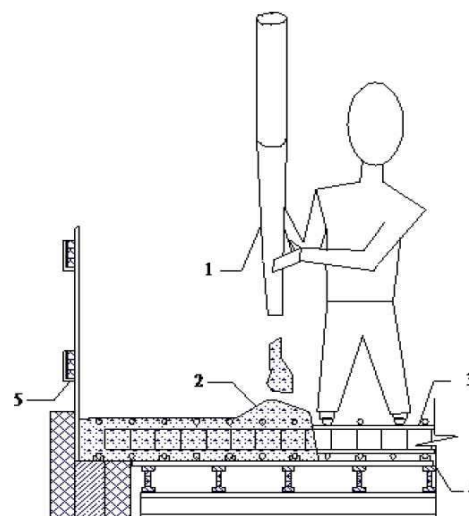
Укладка бетона: 1 - наконечник стрелы автобетононасоса; 2 - укладываемый бетон; 3 - арматурная сетка; 4 - конструкция опалубки перекрытия; 5 - инвентарное ограждение.
